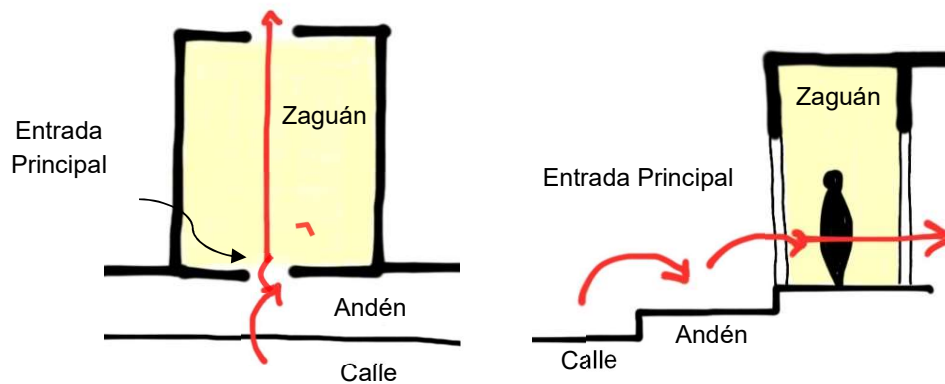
Planta y corte de un zaguán. Nota: Elaboración propia.
